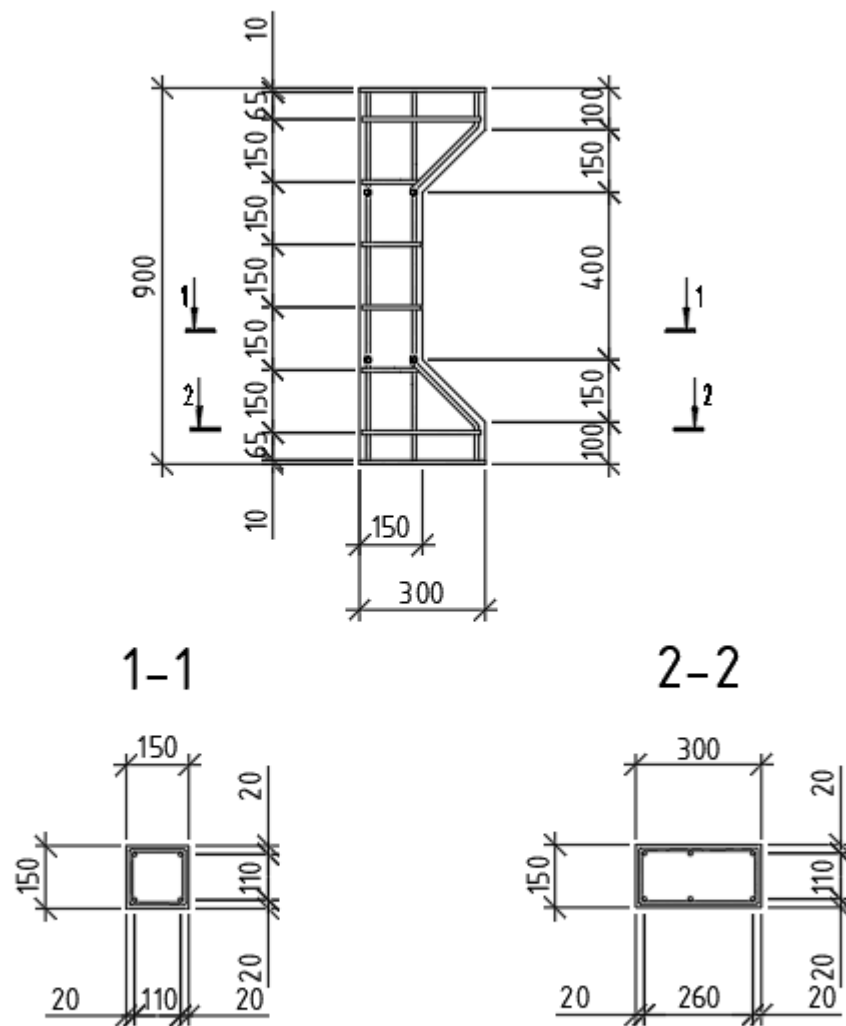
Модель железобетонной колонны сплошного сечения
